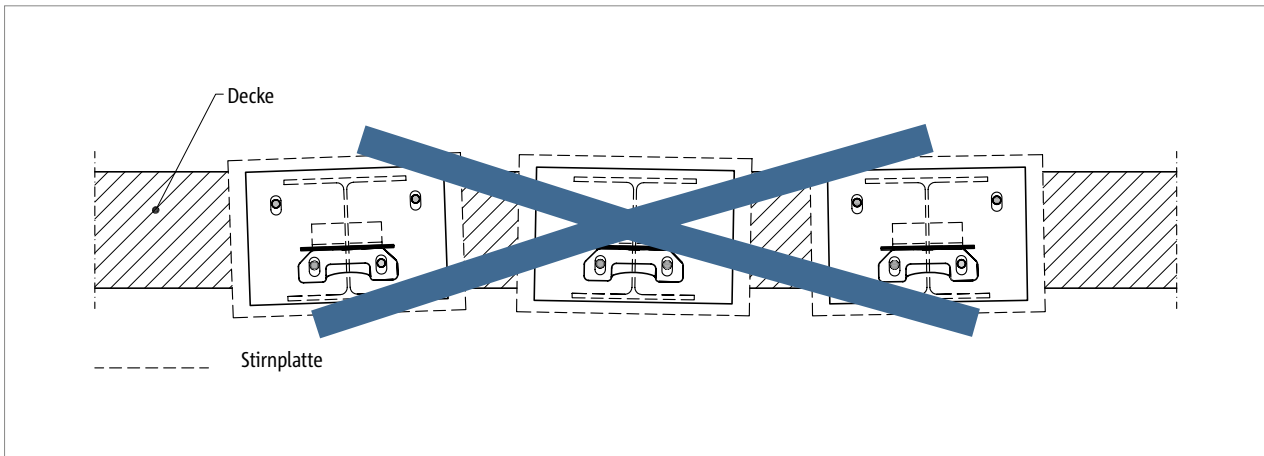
Schöck Isokorb® RT Typ SK: Verdrehte und verschobene Elemente durch ungenauen Einbau
